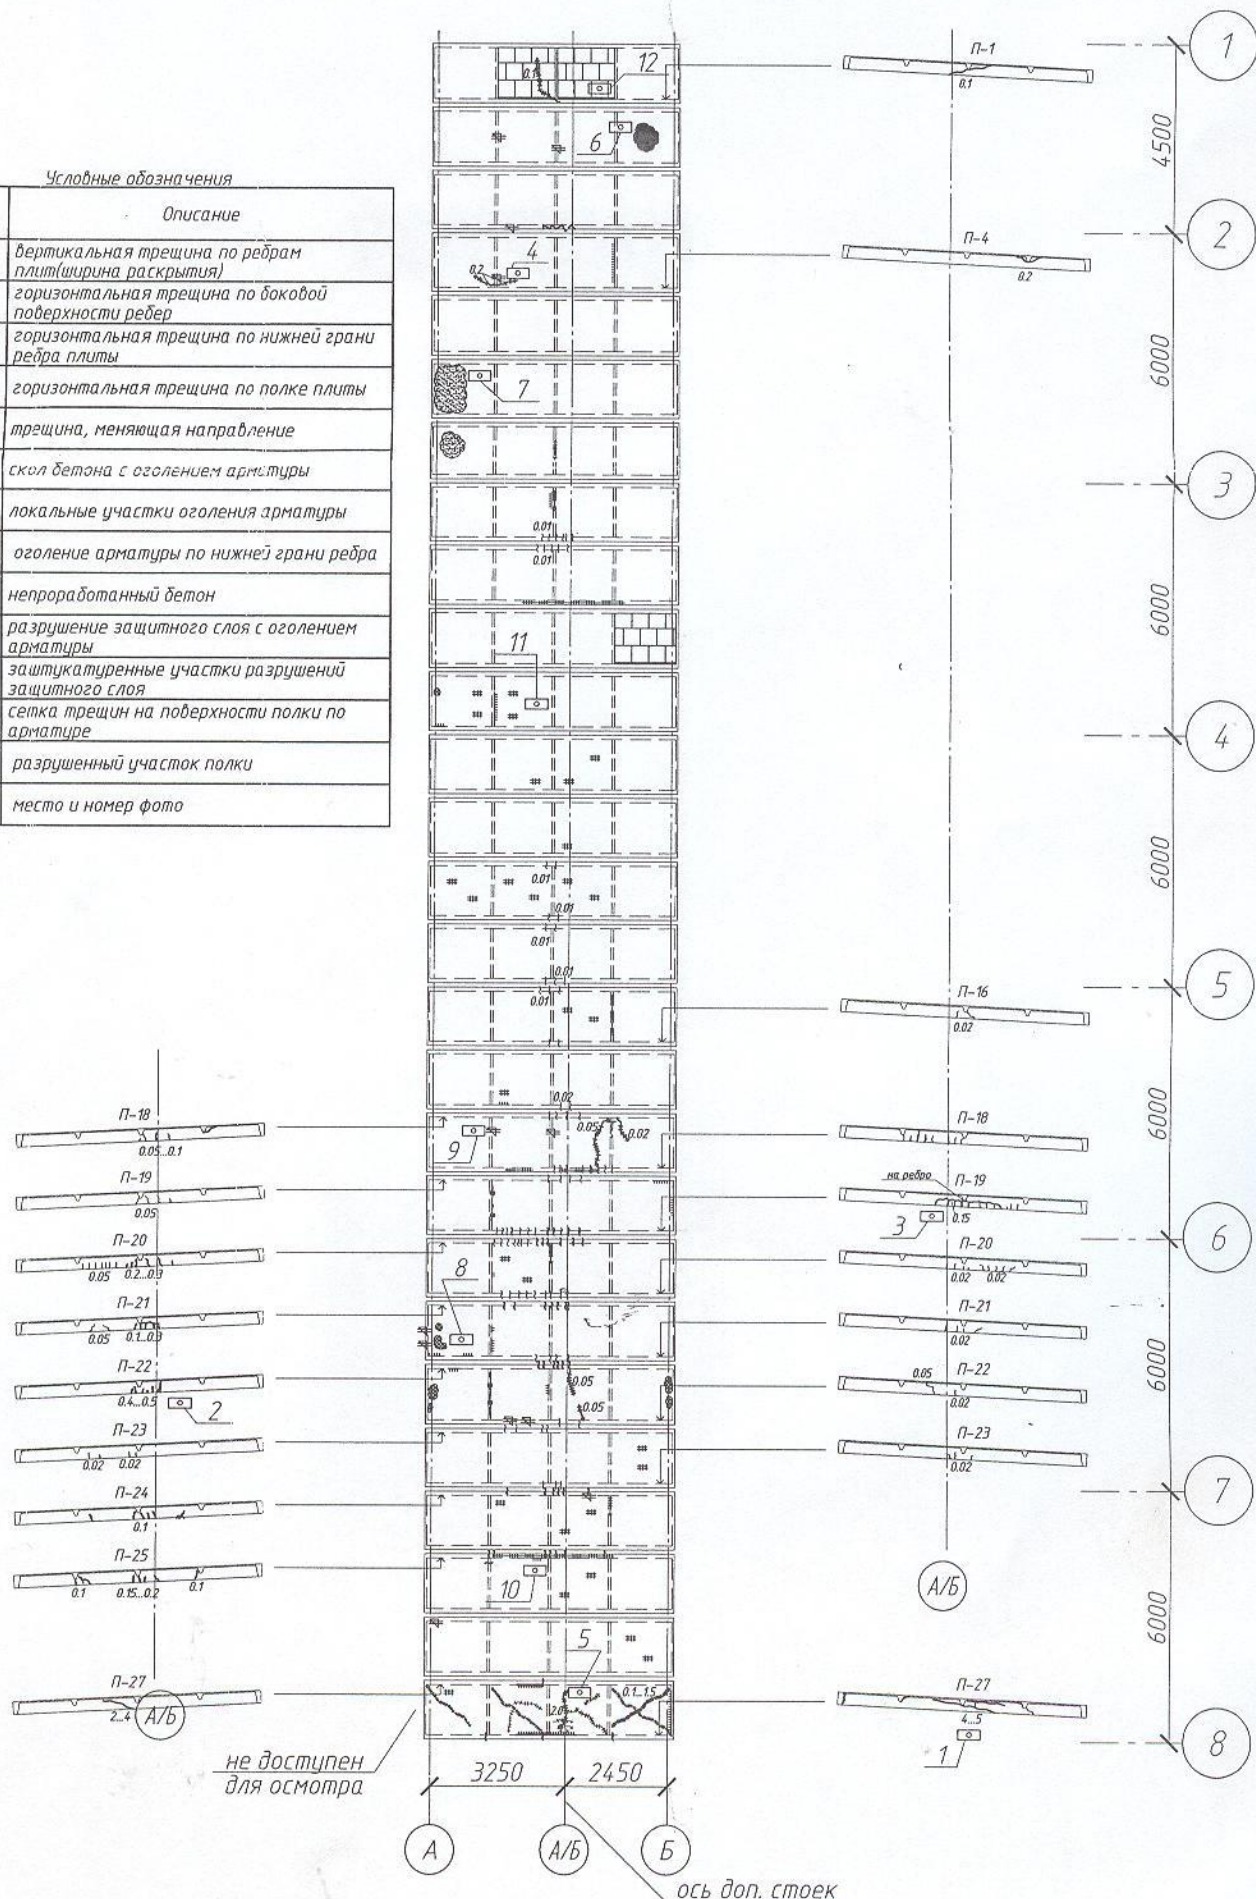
Карта дефектов и повреждений плит перекрытия
